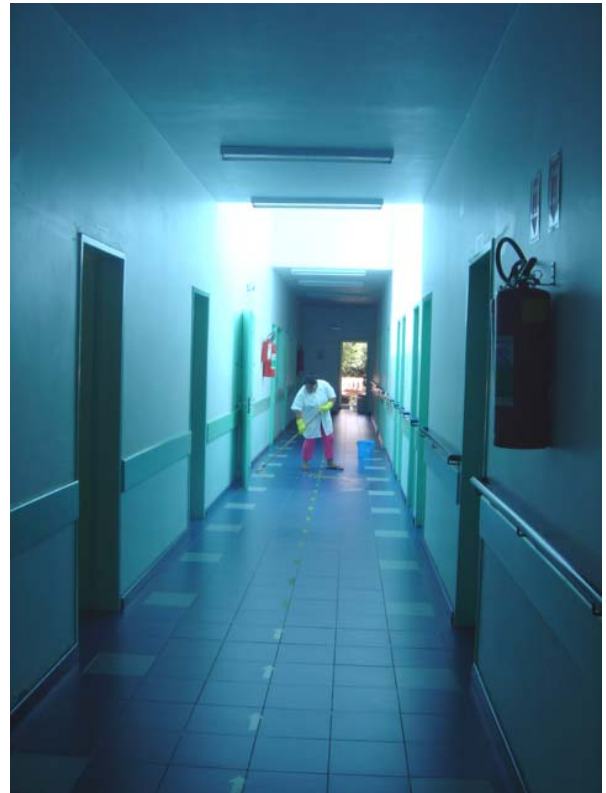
Clarabóia em telhas de fibra de vidro apoiadas em estrutura metálica.
